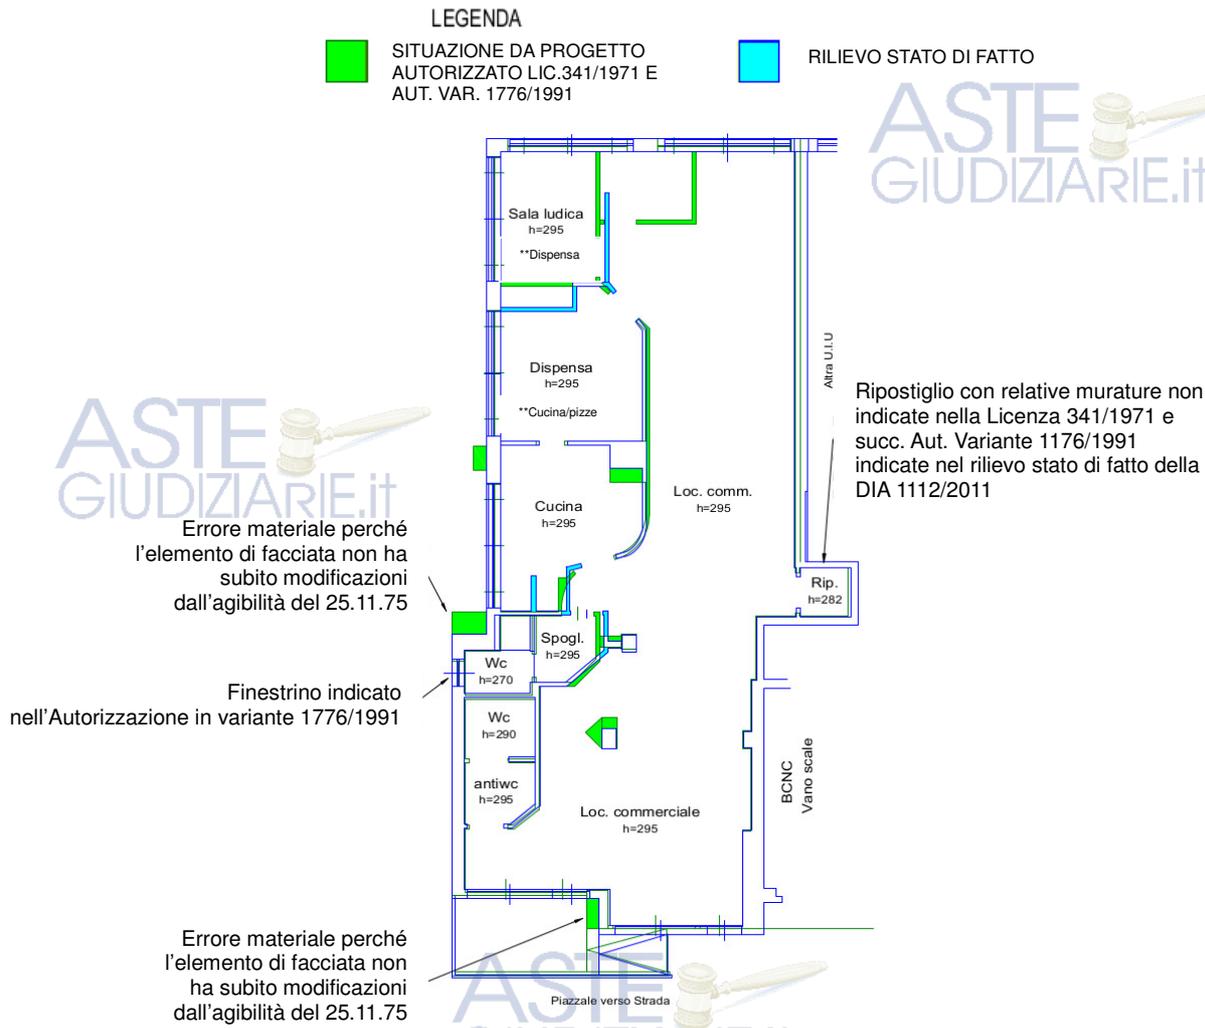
Confronto fra planimetrie rilievo/autorizzato
